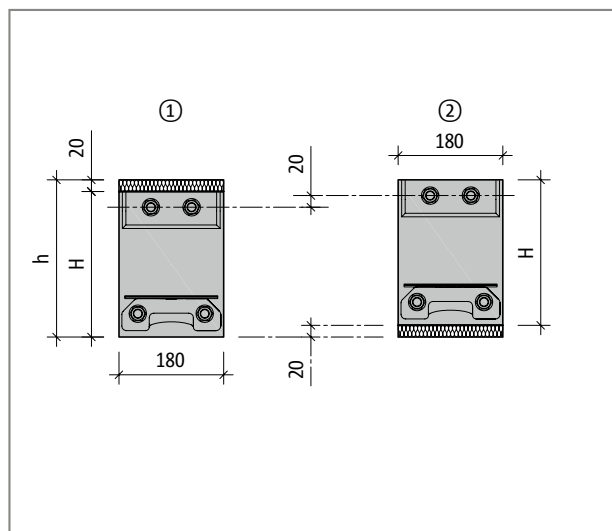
Schöck Isokorb® T type SK : Disposition avec décalage de hauteur
